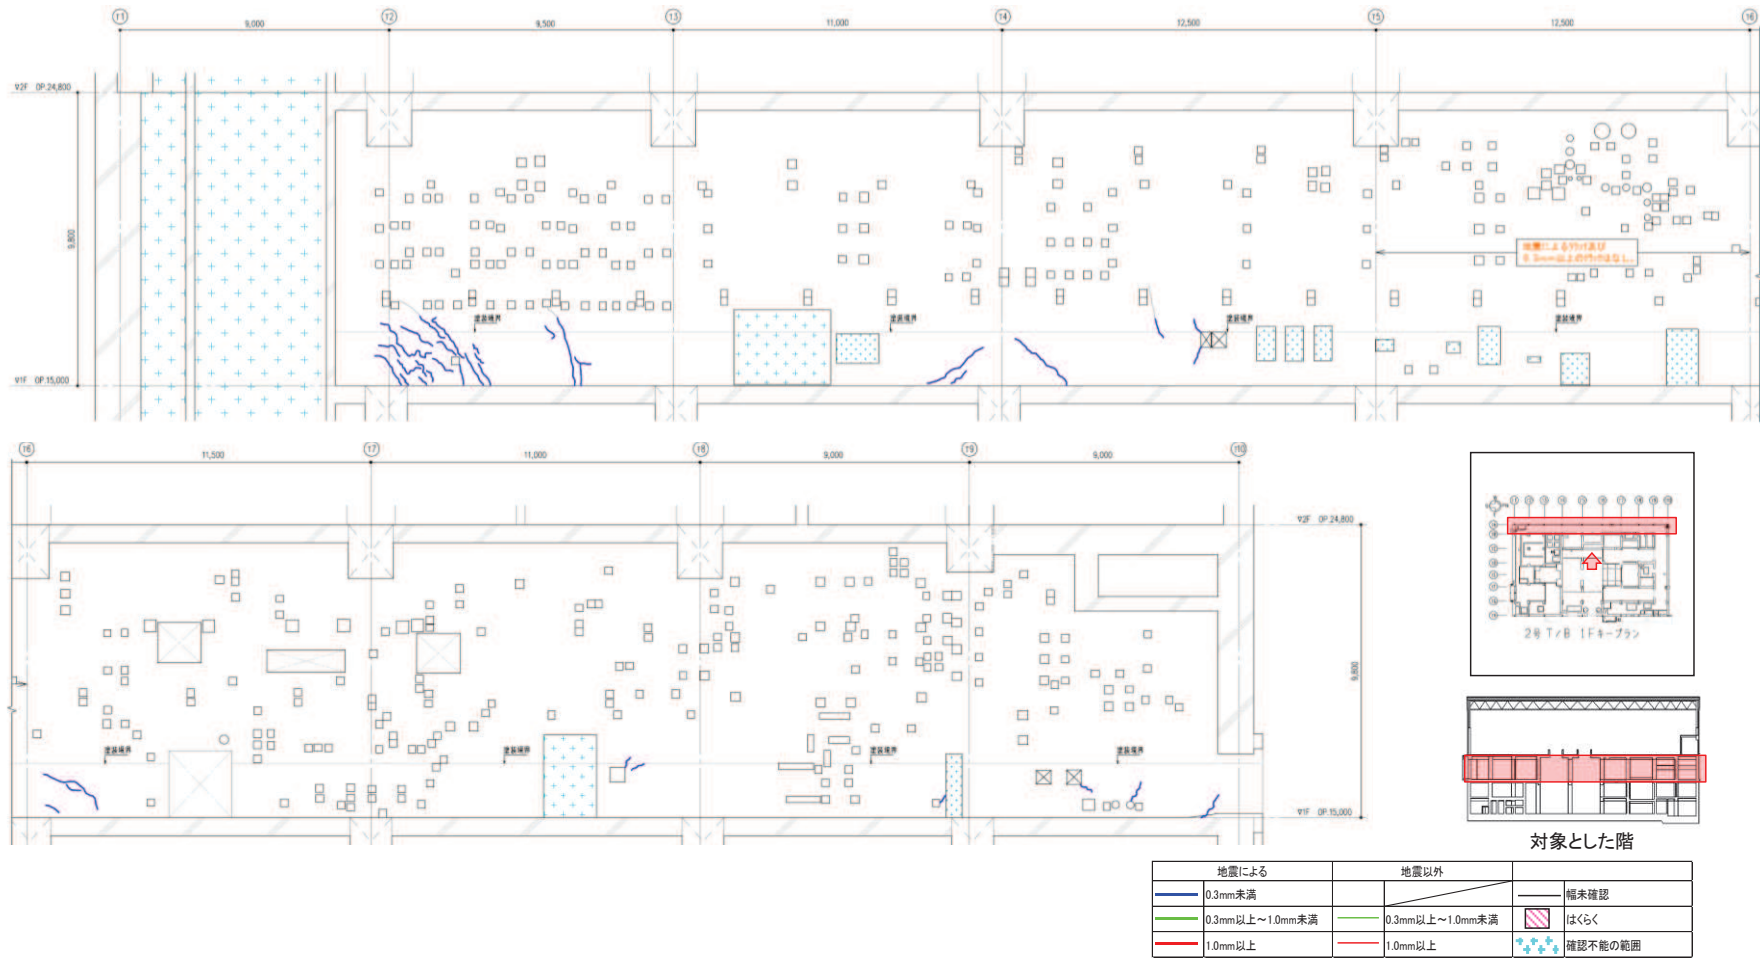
タービン建屋のひび割れ分布 耐震壁 (42) 1階 TA 通り
